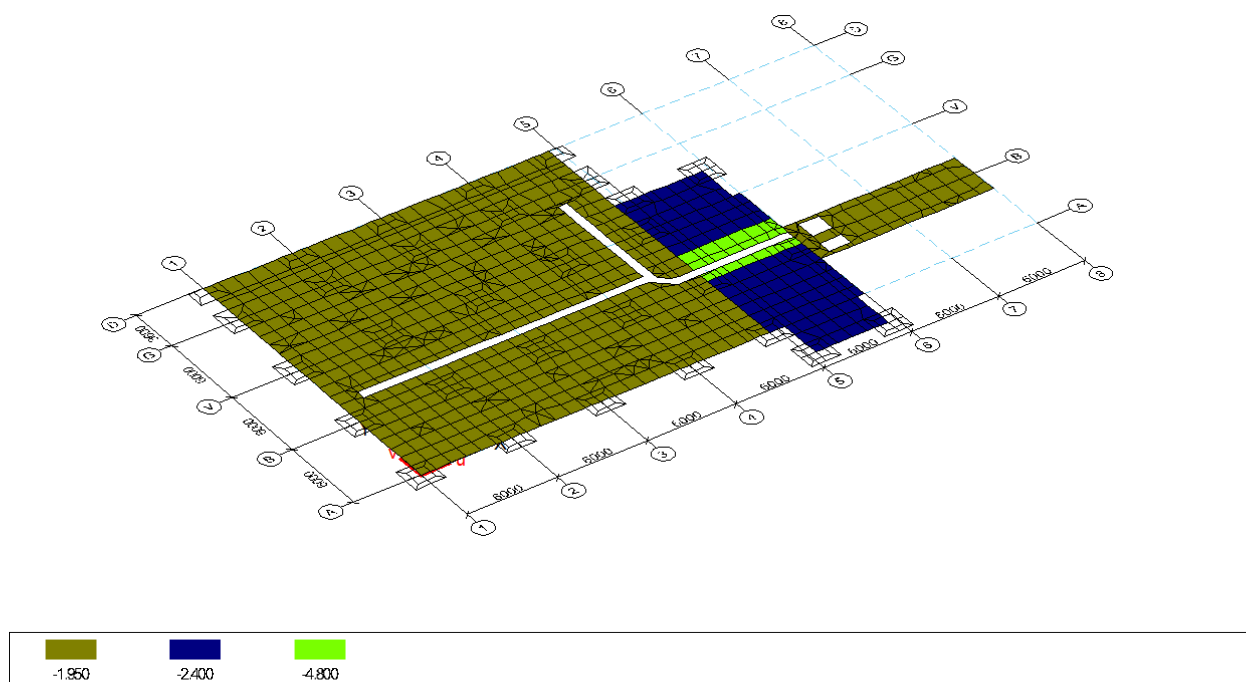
Эксплуатационная нагрузка на перекрытия на отм. 0,000
